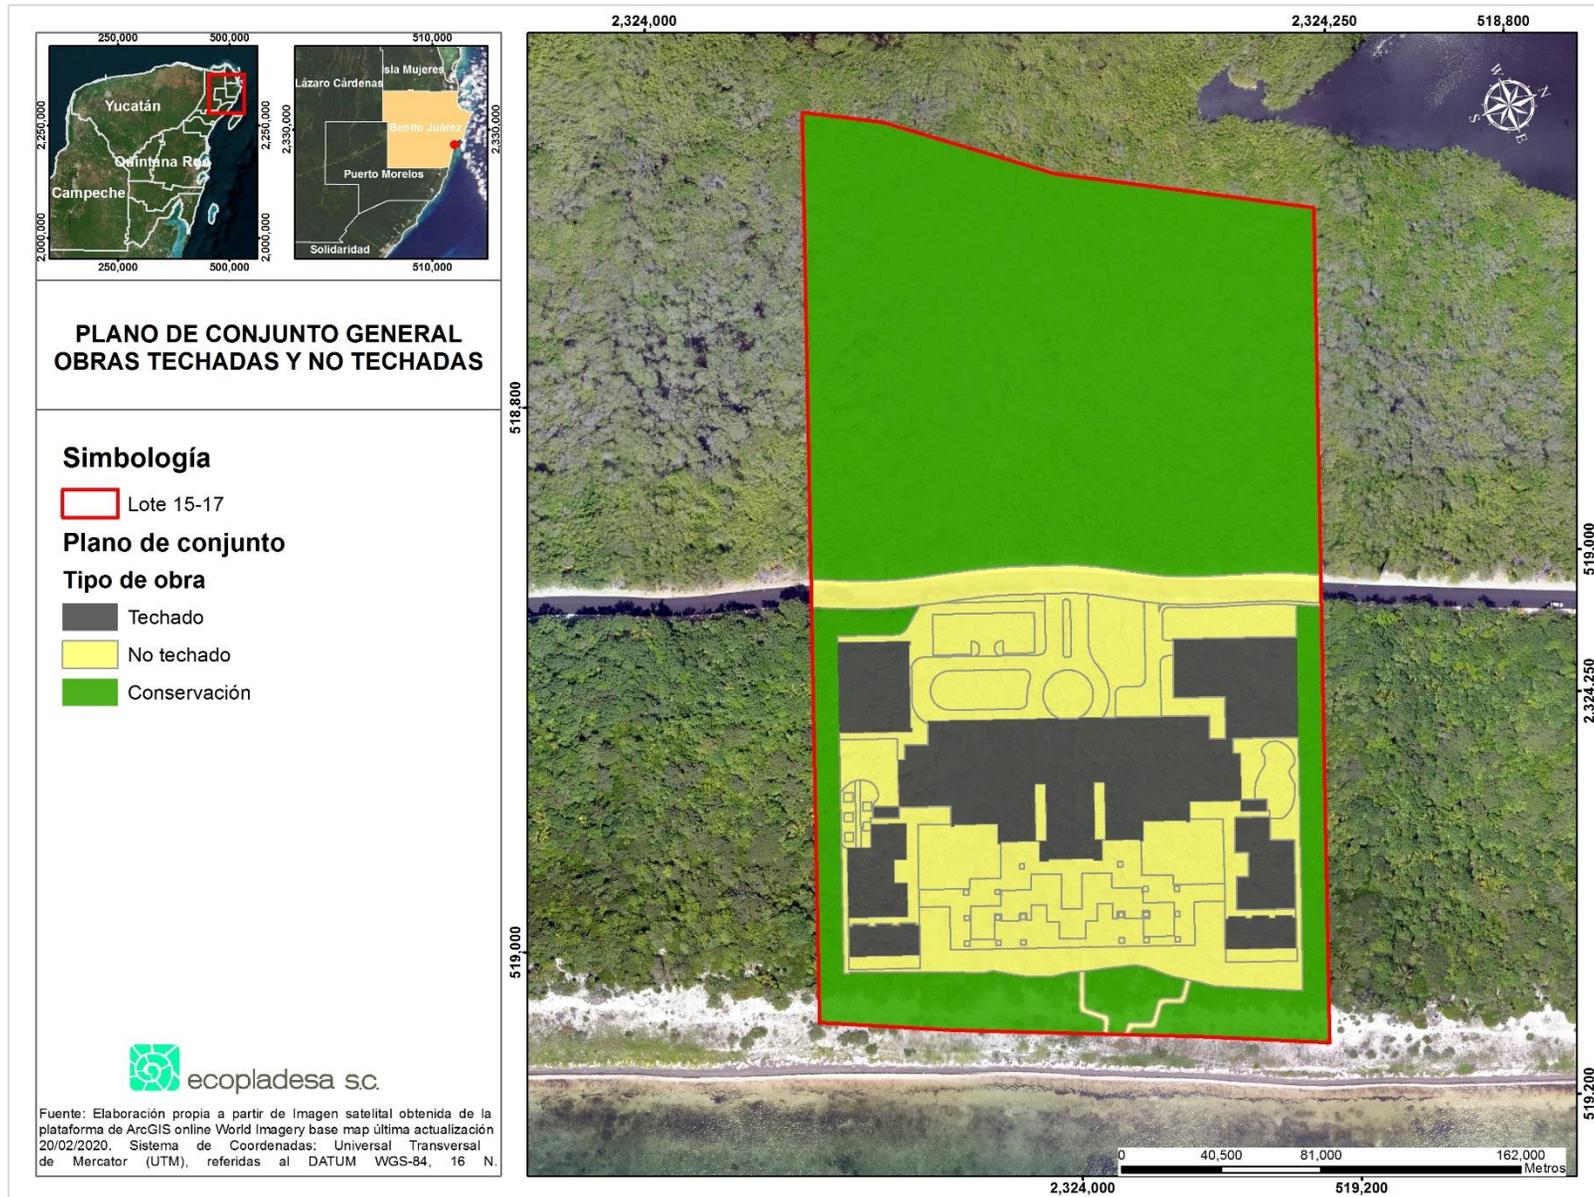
Se presenta el plano de conjunto donde se muestran las obras techadas y no techadas.
